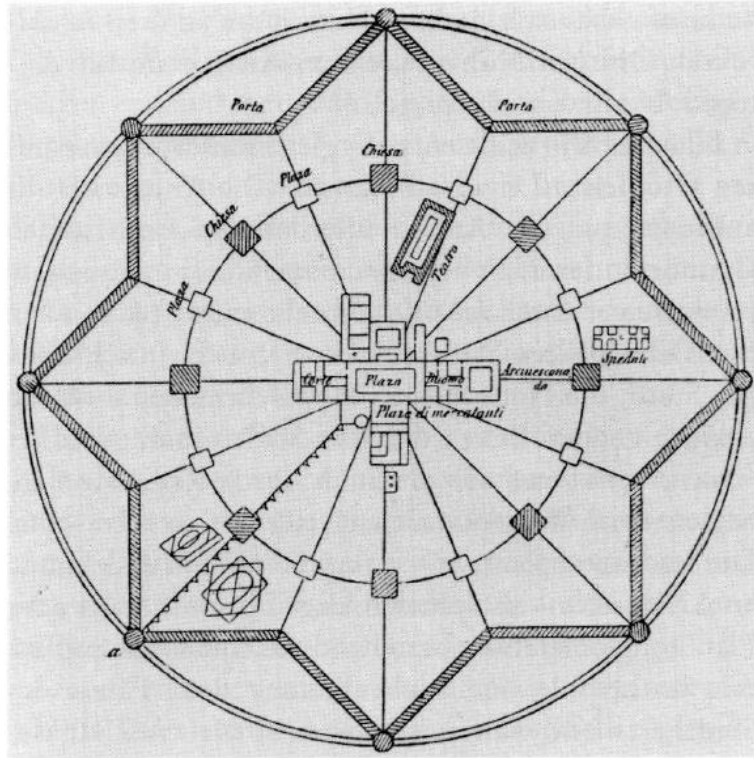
Antonio di Pietro Averlino (Filarete), Plan der Idealstadt Sforzinda, 1457.
